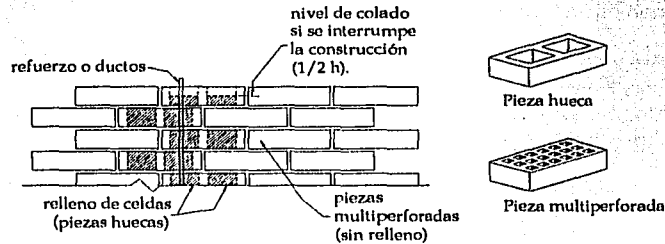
Relleno de piezas en muros con piezas huecas y multiperforadas.
